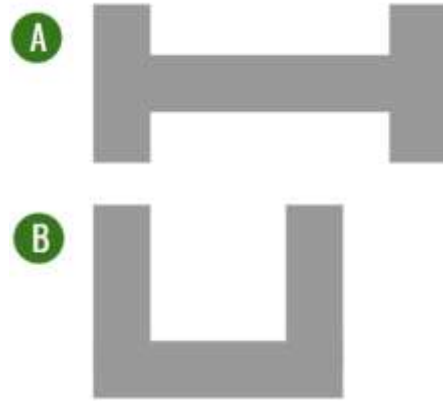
Esquemas de geometría en planta de Escuela Zamorano. Fuente: Elaboración propia.
